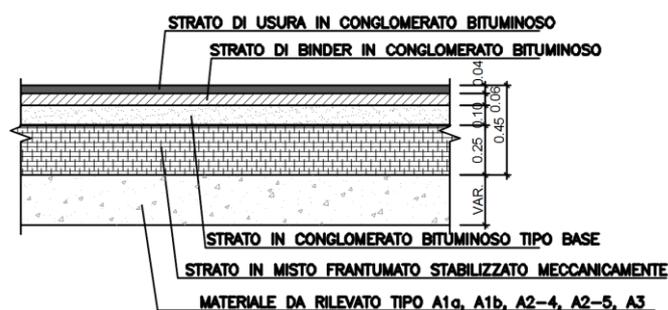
Pacchetto pavimentazione nell'opera di progetto
